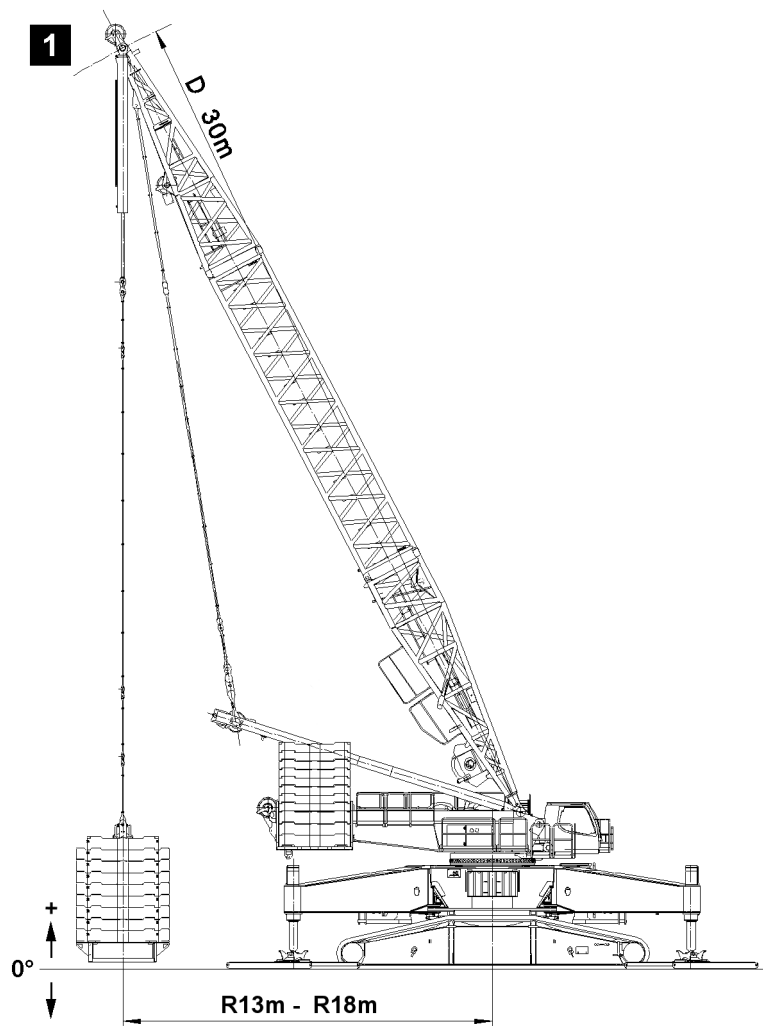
Alturas de elevação do lastro Derrick sem guia do lastro em suspensão
